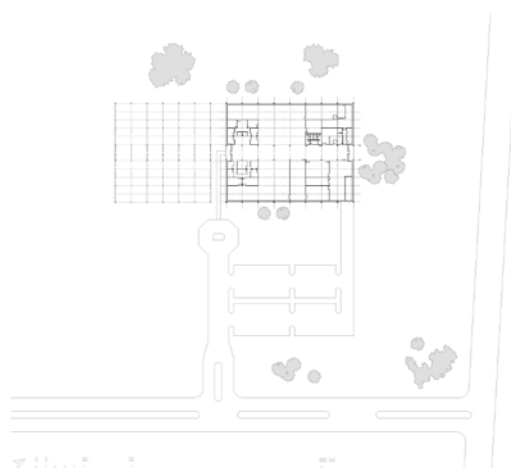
Plano de la planta de distribución de la fábrica PA Technology. Fuente: Elaboración propia.
